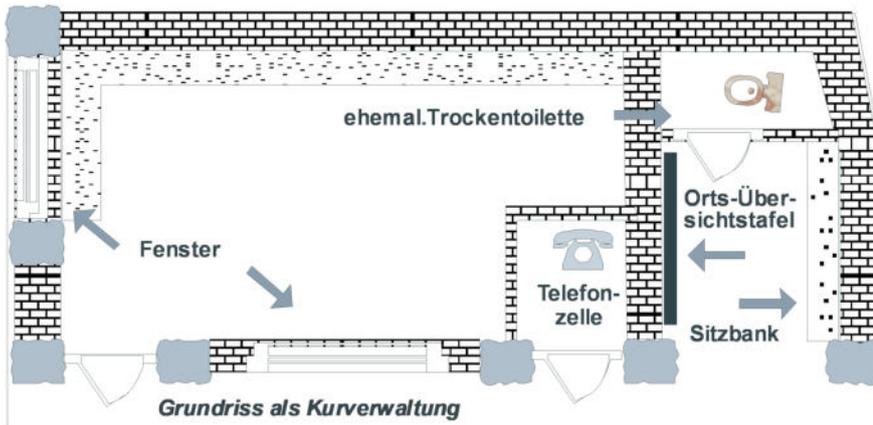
Grundriss nach dem Umbau der Wartehalle zur Kurverwaltung
